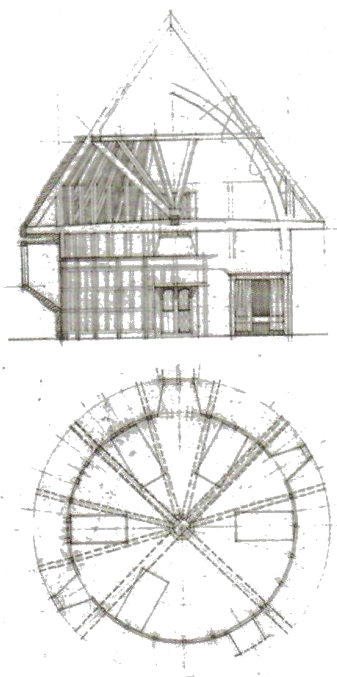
Sección y planta del dormitorio de chicos de la casa Gryffindor
